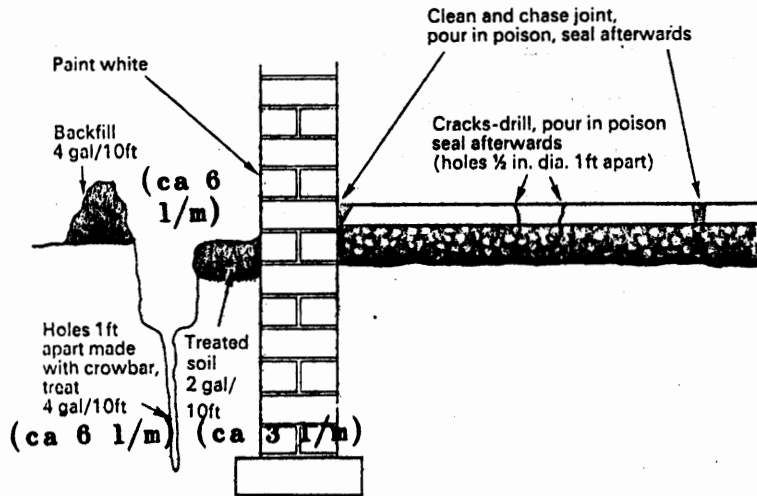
Efterbehandling vid grundkonstruktion med grundmur och flytande platta på mark
